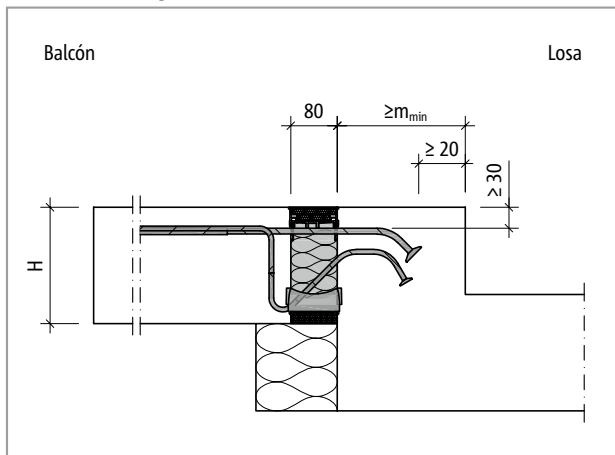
Schöck Isokorb® T tipo K-O: Balcón con desplazamiento de altura hacia arriba y aislamiento externo
